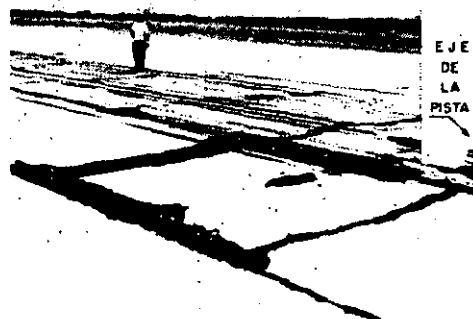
Grietas ya reparadas con material asfáltico
